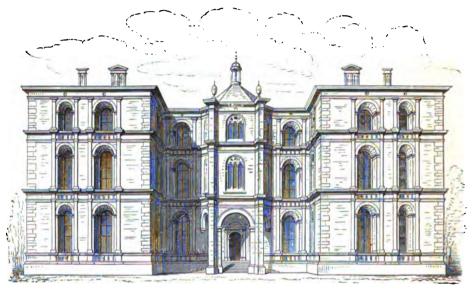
Schlofs Chalvau. Vordere Façade. (Du Cerceau.)
